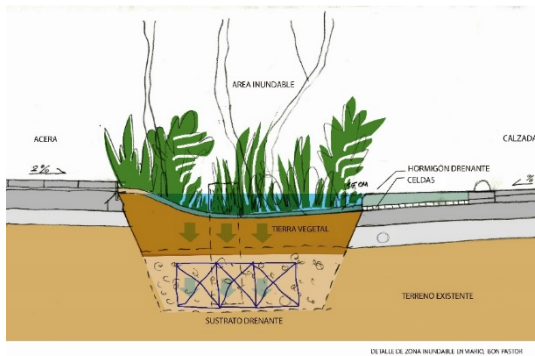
Calle Biosca. Detalle constructivo de franja de biorretención.
